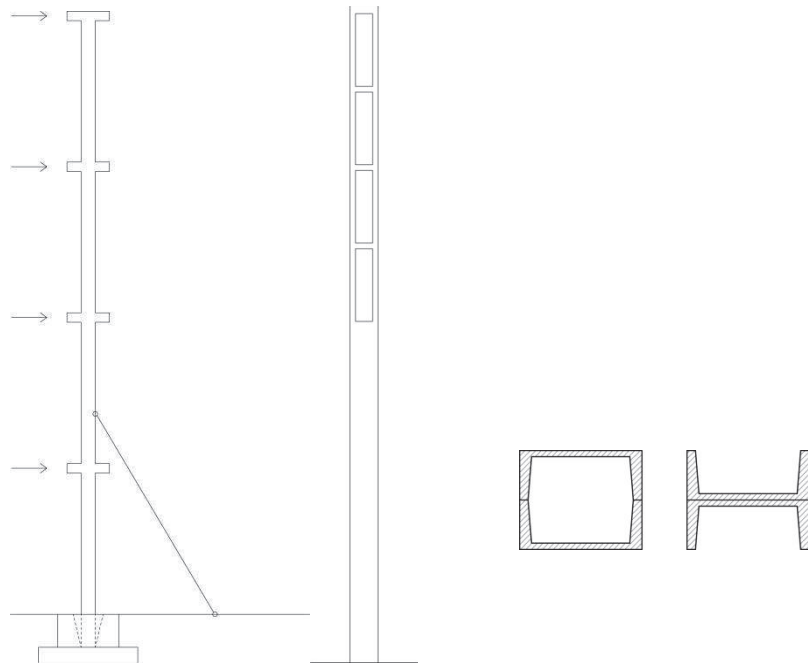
pilastro con puntello di irrigidimento, pilastro alleggerito e accoppiamento di due "C" in cls, autore tesi
